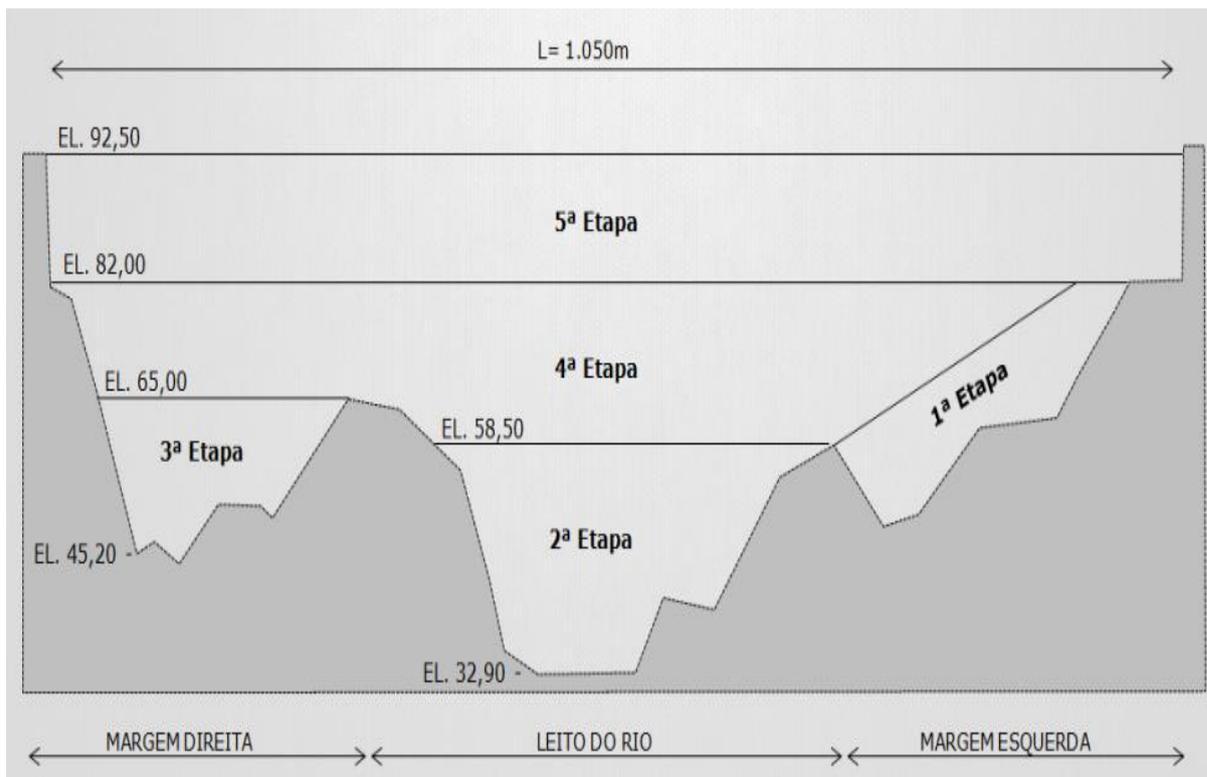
Seção longitudinal esquemática – Fases da construção
